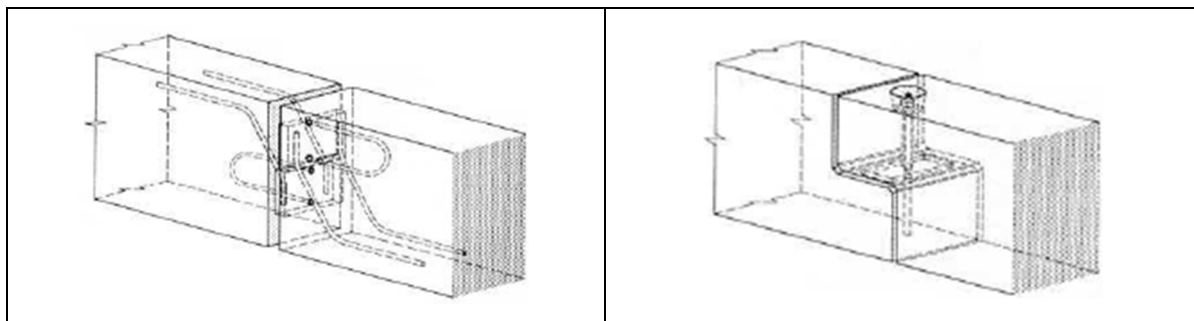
Ligação por chapas metálicas verticais (Stupré, 1981)
